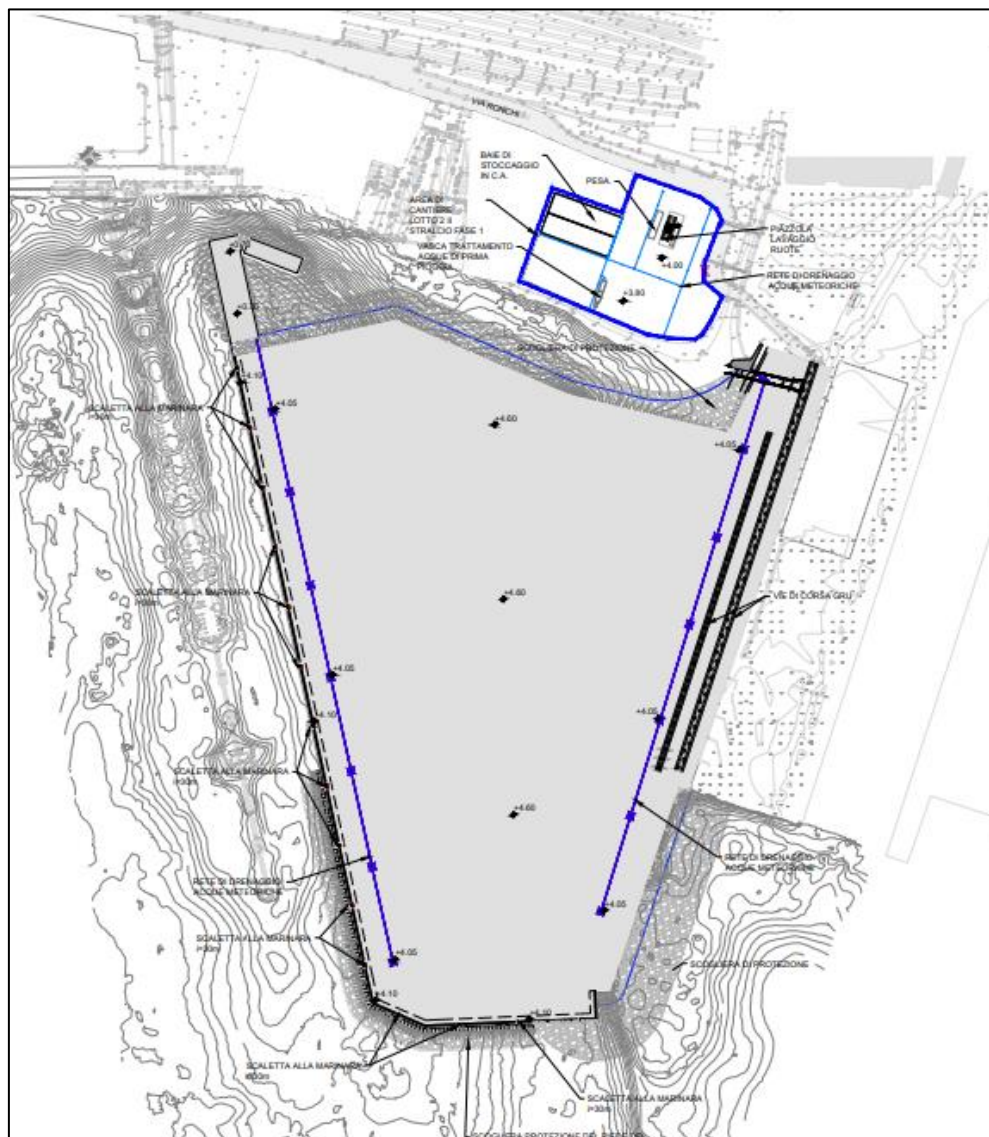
Planimetria con indicazione della parte della cassa di colmata in corso di realizzazione con la Fase 1 di intervento del Lotto 2 II Stralcio
